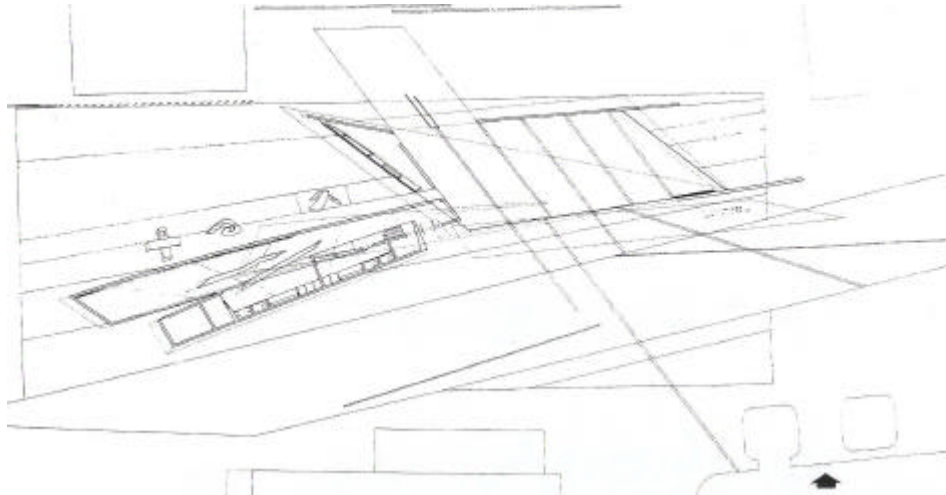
Zaha Hadid, Feuerwache, 1989-1993, Grundriß Erdgeschoß
